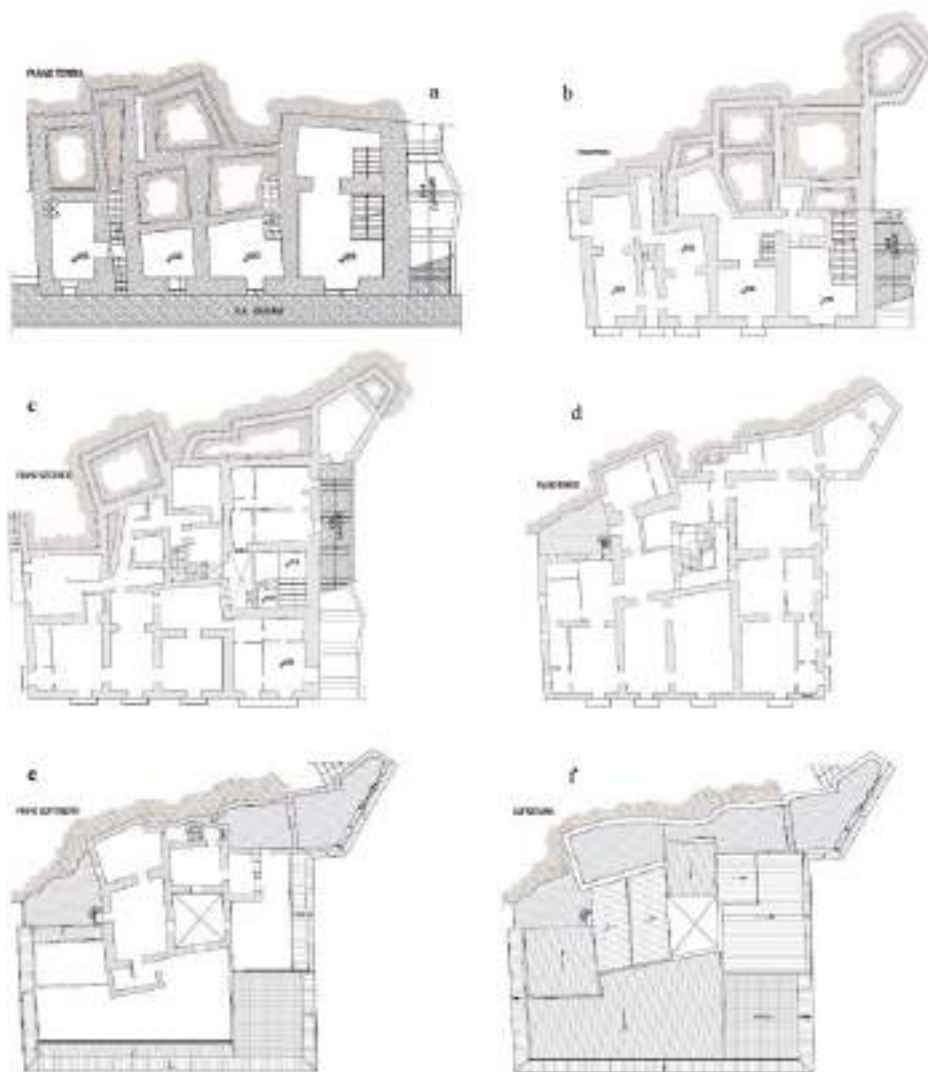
a) Piano Terra; b) Piano Primo; c) Piano Secondo; d) Piano Terzo; e) Sottotetto; f) Copertura
